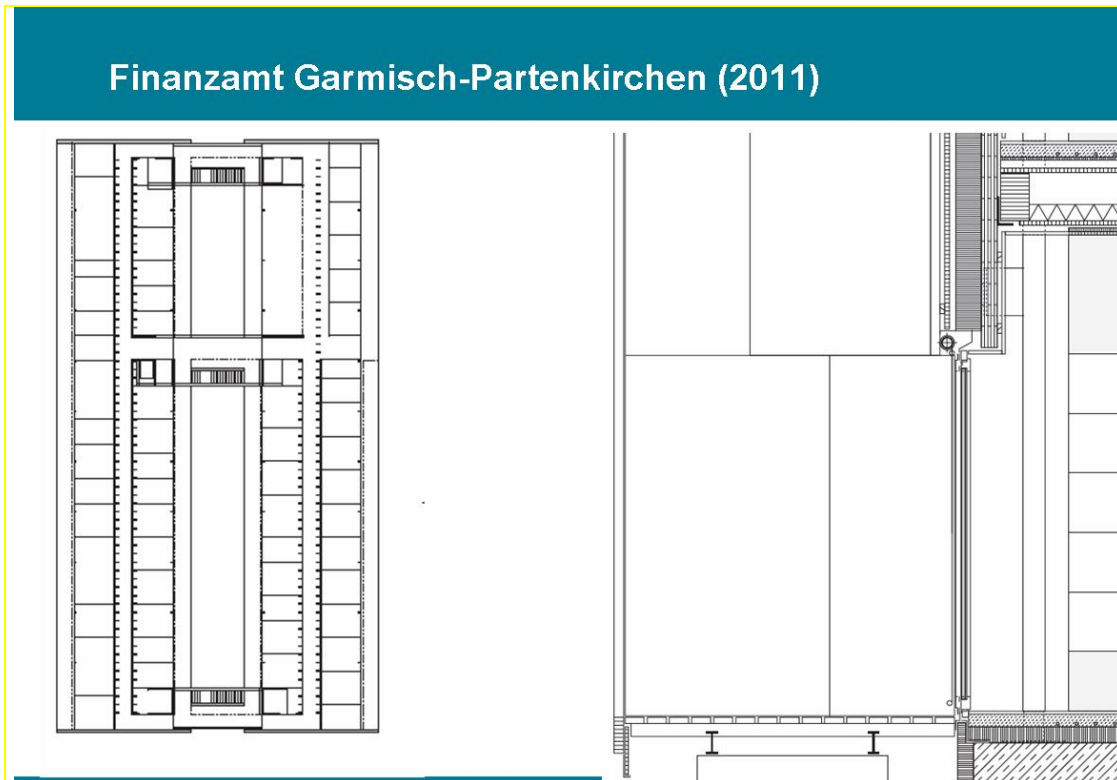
Finanzamt Garmisch – Partenkirchen Grundriss, Detailschnitt
